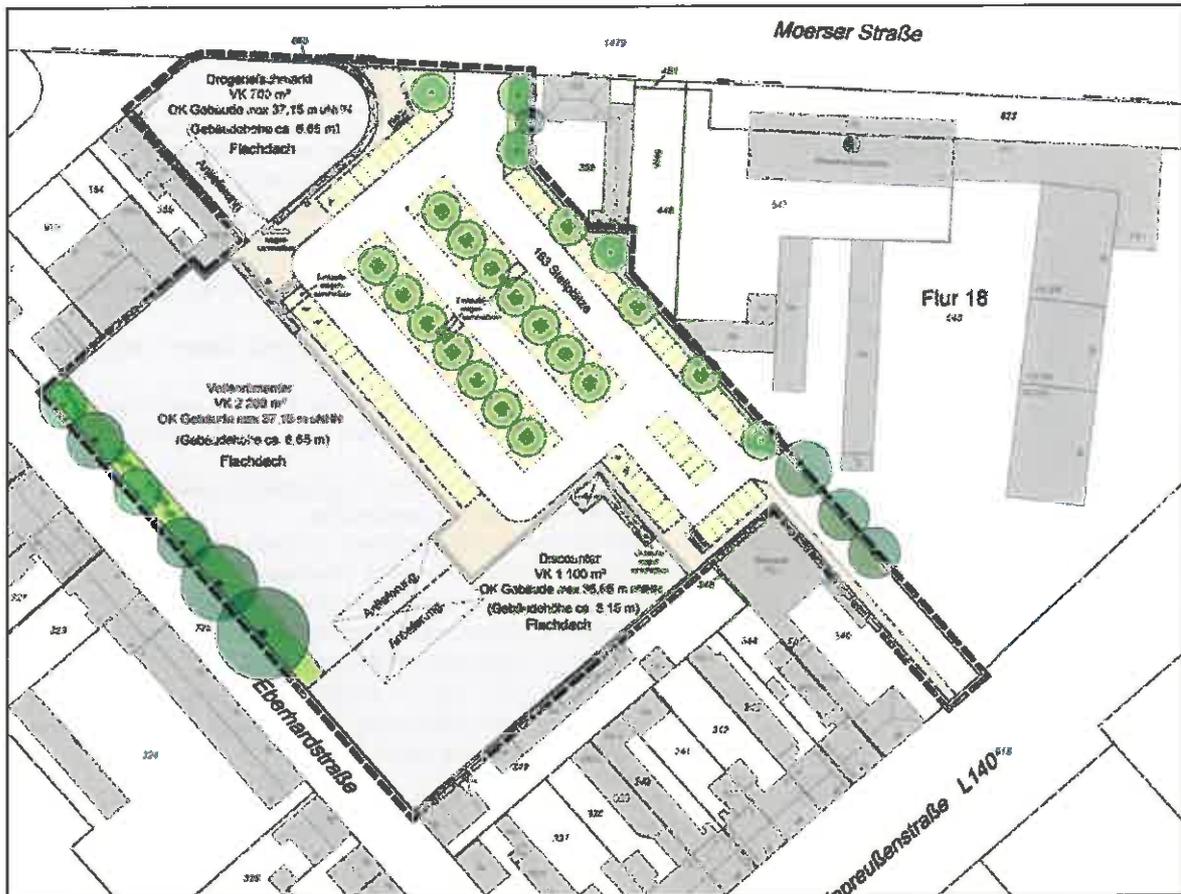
Vorhaben- und Erschließungsplan (ISR Stadt + Raum)
